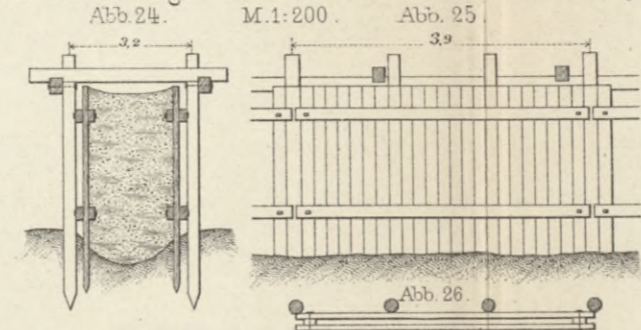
Fangdamm vom Bau der Brücke zu Neuilly.
